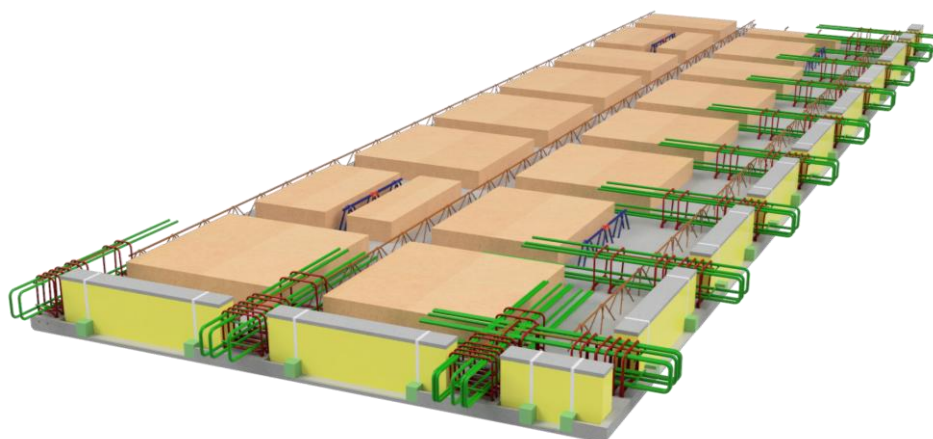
ML3 - cas d'une Dalle WOODlite avec rupteurs ThermoPrédalle® BA 0,45 RECTOR en angle
